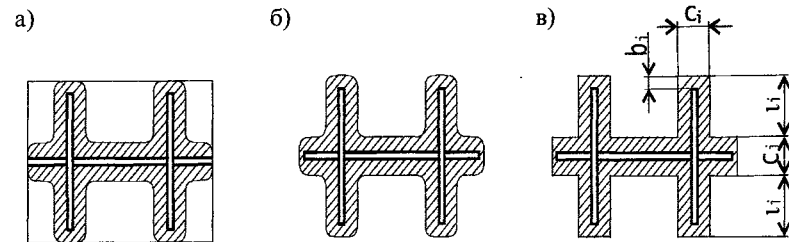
Зоны передачи реакции с опорной плиты на фундамент
